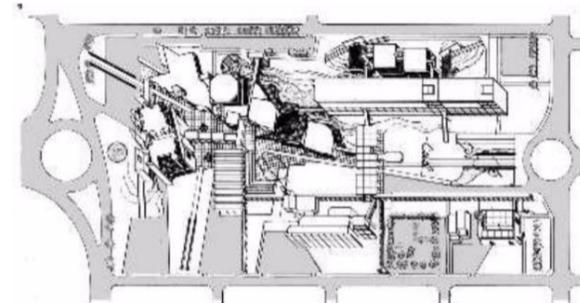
planta de Centro Cívico Santa Rosa La Pampa, Argentina 1959.
